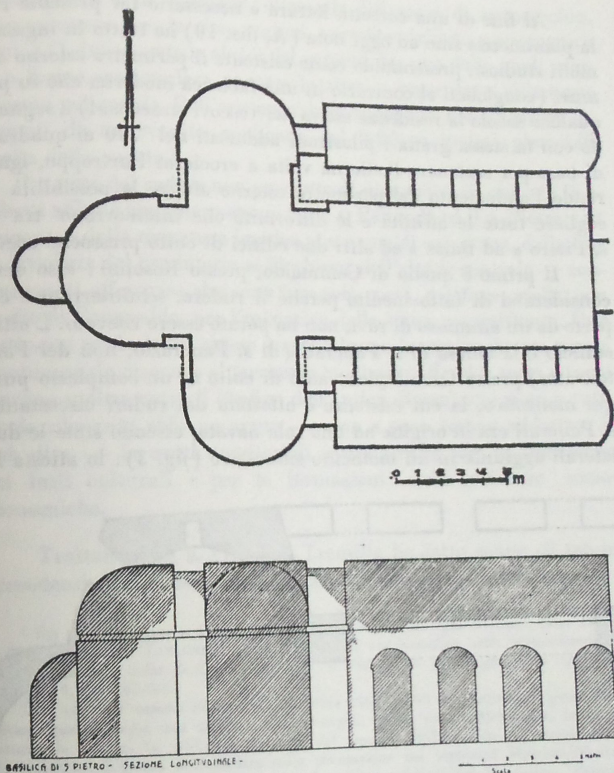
Planimetria (in alto) e sezione longitudinale (in basso) della chiesa di s. Pietro ad Baias.
